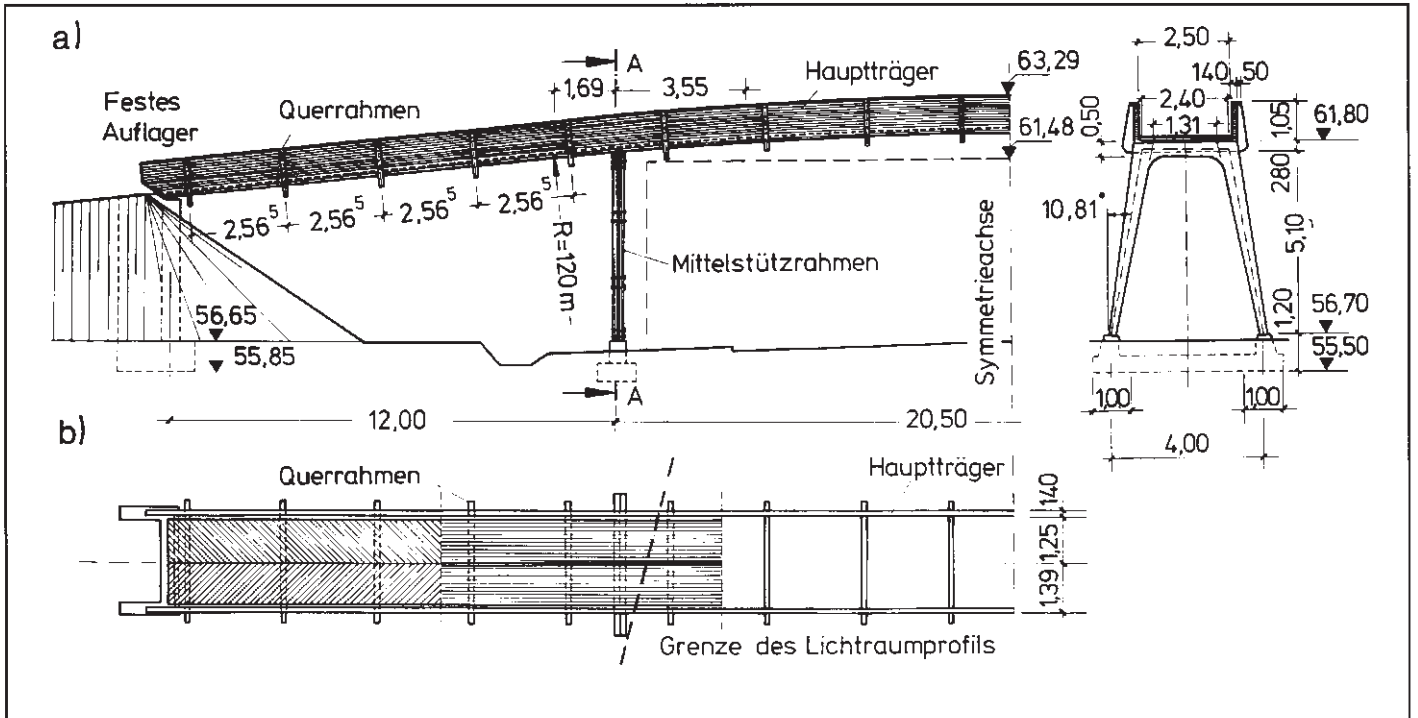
Brücke über die Bundesstraße B 51 bei Münster, Übersicht
